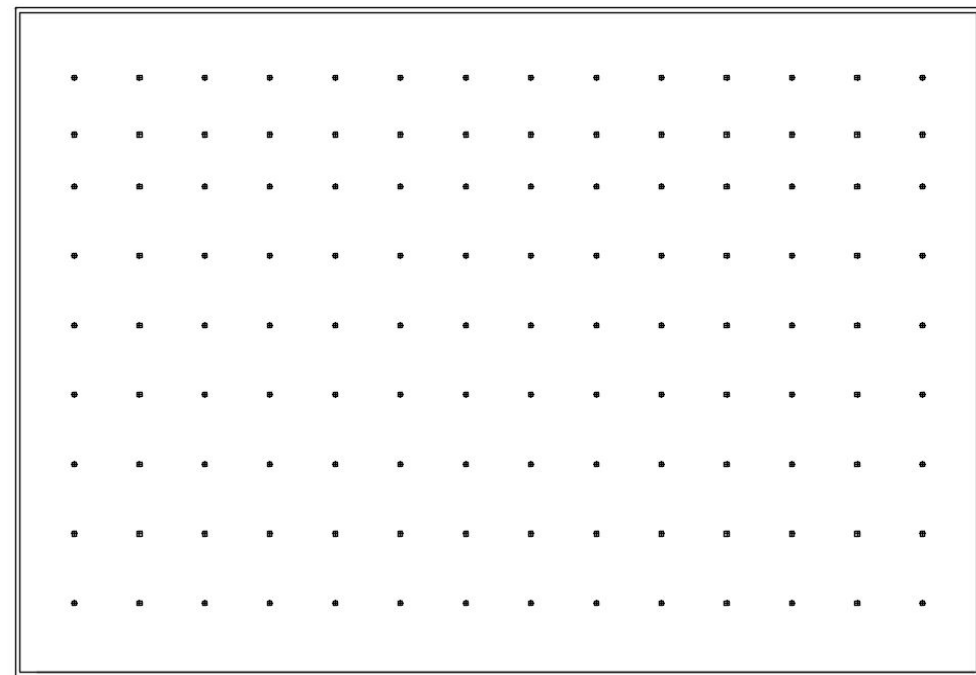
Distribución en planta sin estructura de piscina. Fuente: Propia
